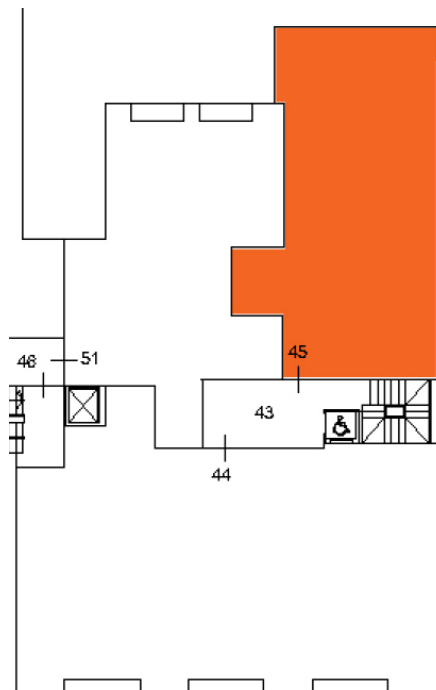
Stralcio elaborato planimetrico primo piano con individuazione del subalterno 44
